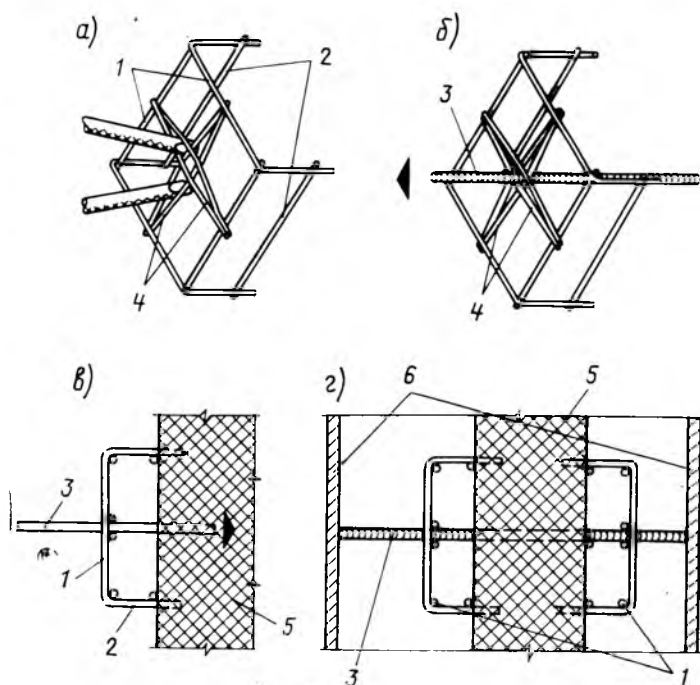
Установка анкерной связи для монолитных стен на теплоизоляционный слой
